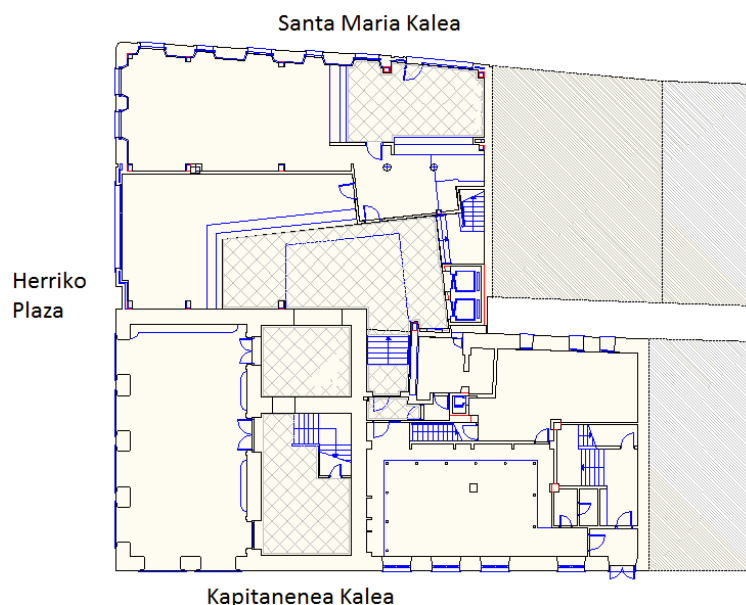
VISTA DE PLANTA BAJA DEL AYUNTAMIENTO
